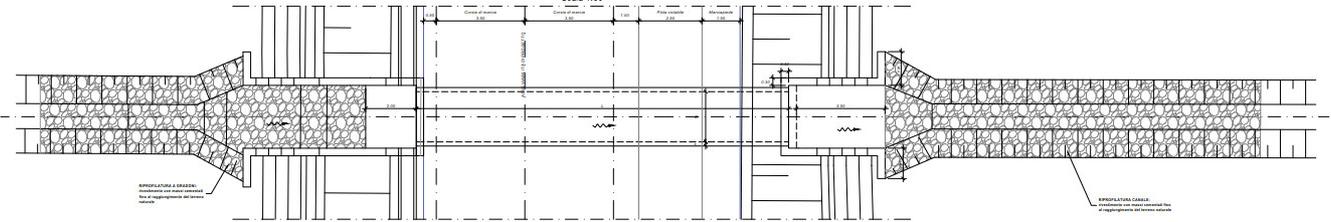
Sezione longitudinale tipologica tombino di attraversamento stradale
